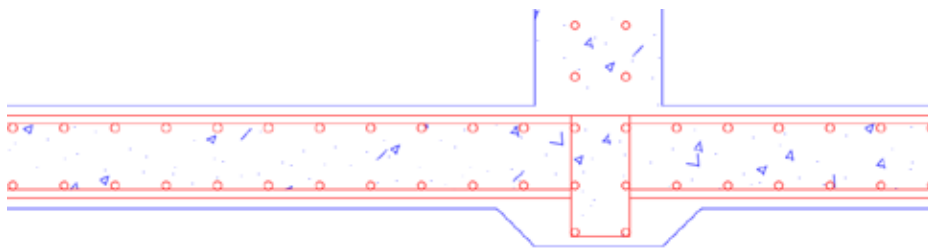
Detalle de Losa de Fundación de la estructura. (2017)
